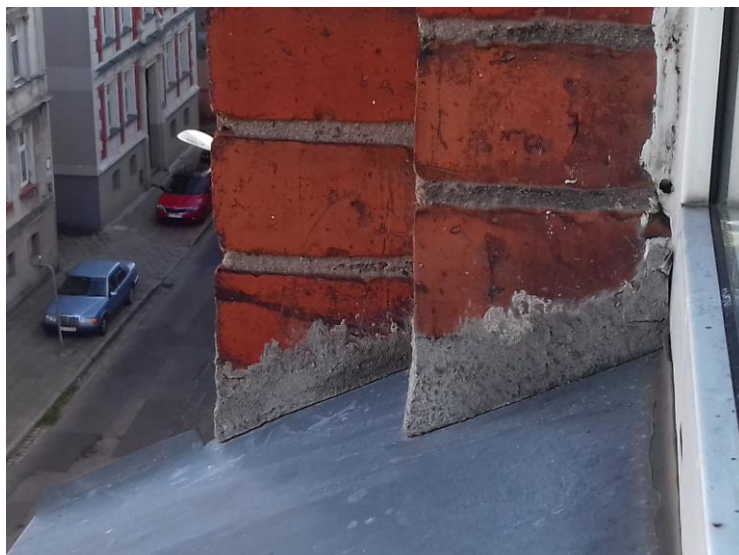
Elewacja szczytowa : widoczne zniszczenie cegły licowej w obrębie rur spustowych.
